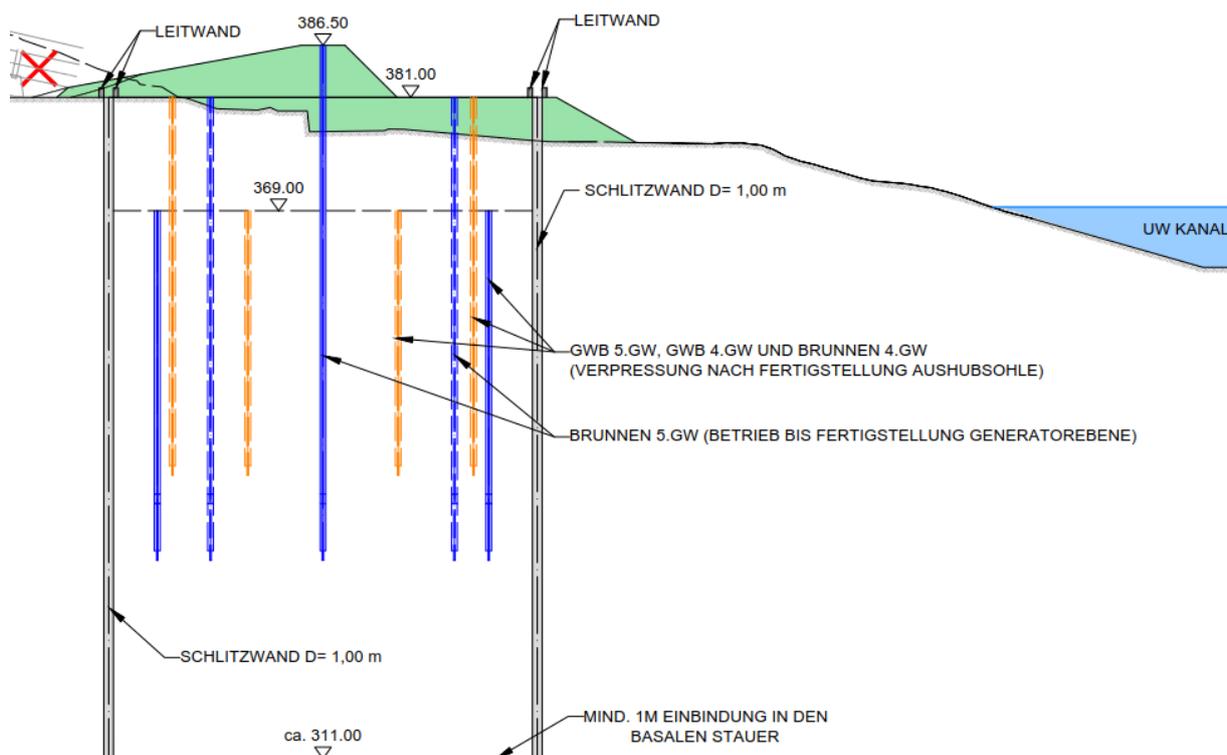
Baugrubenvariante mit tief einbindender Schlitzwand und Wasserhaltungen innerhalb der Baugrube
